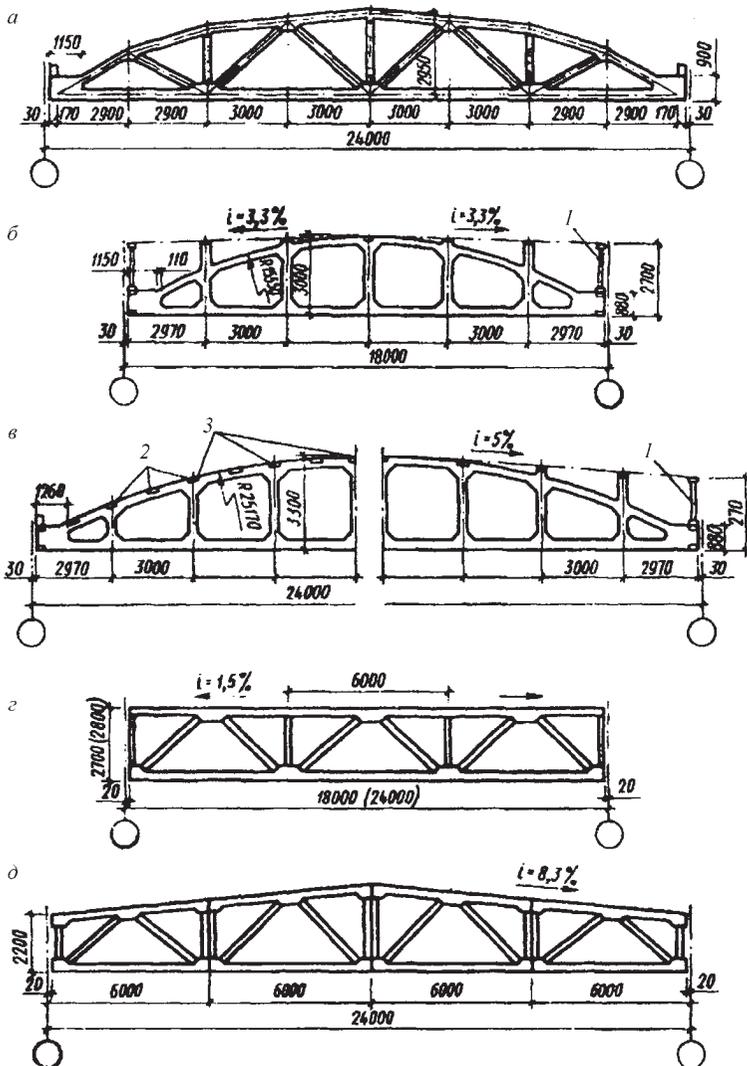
Железобетонные фермы: а – сегментная раскосая; б – безраскосая для малоуклонных кровель пролетом 18 м; в – безраскосая ферма пролетом 24 м; г – с параллельными поясами; д – полигональные сборные; 1 – стальная стойка; 2 – закладные детали для плит шириной 1,5 м; 3 – то же, 3 м
